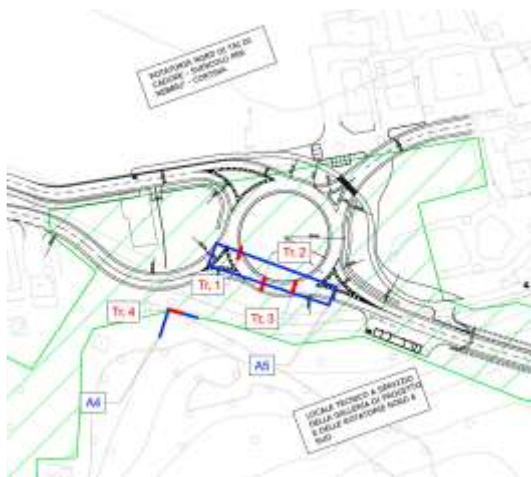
Stralcio planimetria ubicazione indagini: dettaglio Svincolo Tai Ovest
